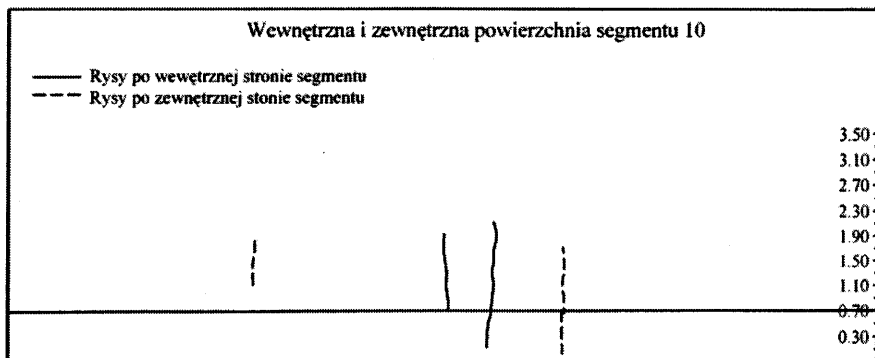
Układ rys na zewnętrznej powierzchni segmentu 10
